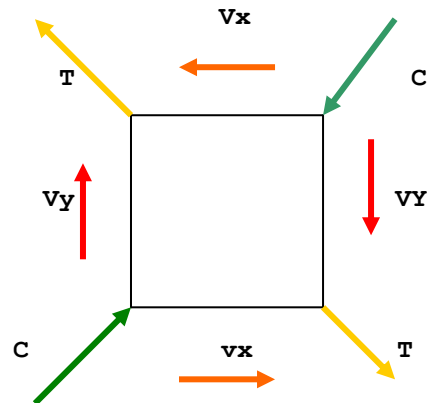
38.- Fuerzas actuantes en un elemento "D" de la conexión interior viga - columna.
